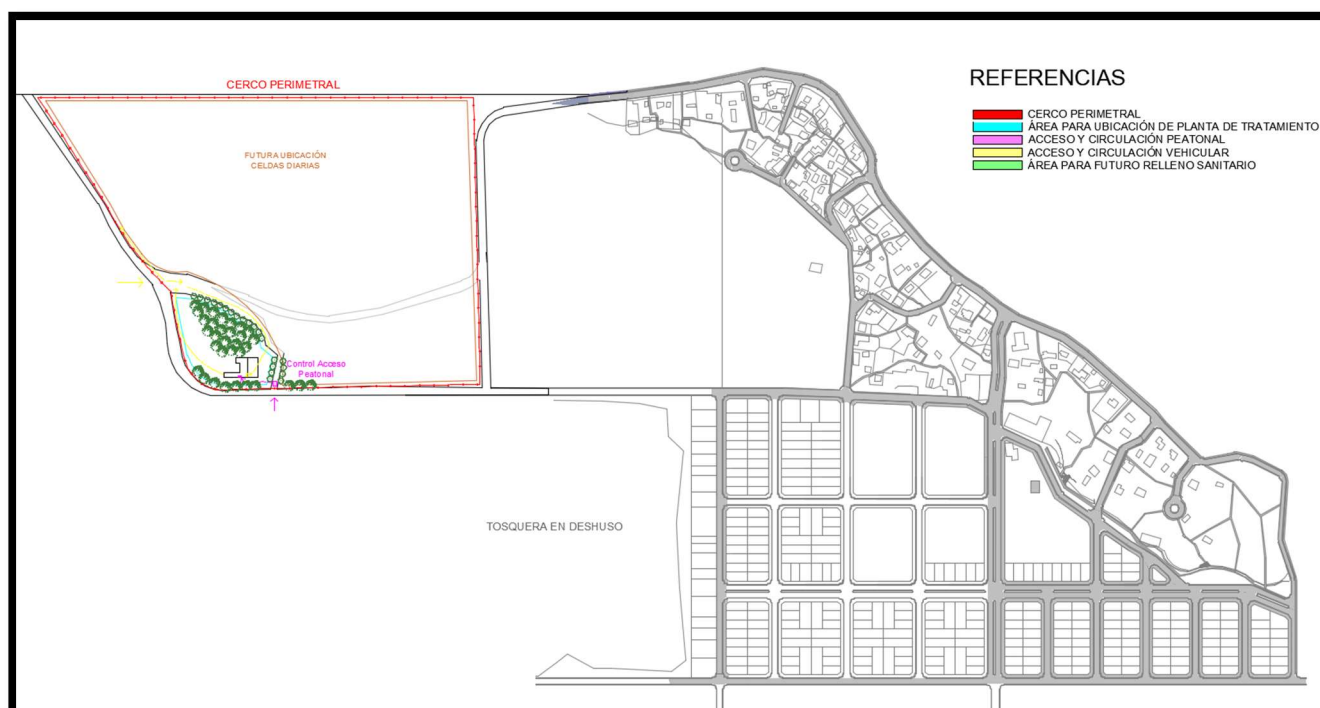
Plano de Implantación Futuro Relleno Sanitario – Fuente: Elaboración Propia
